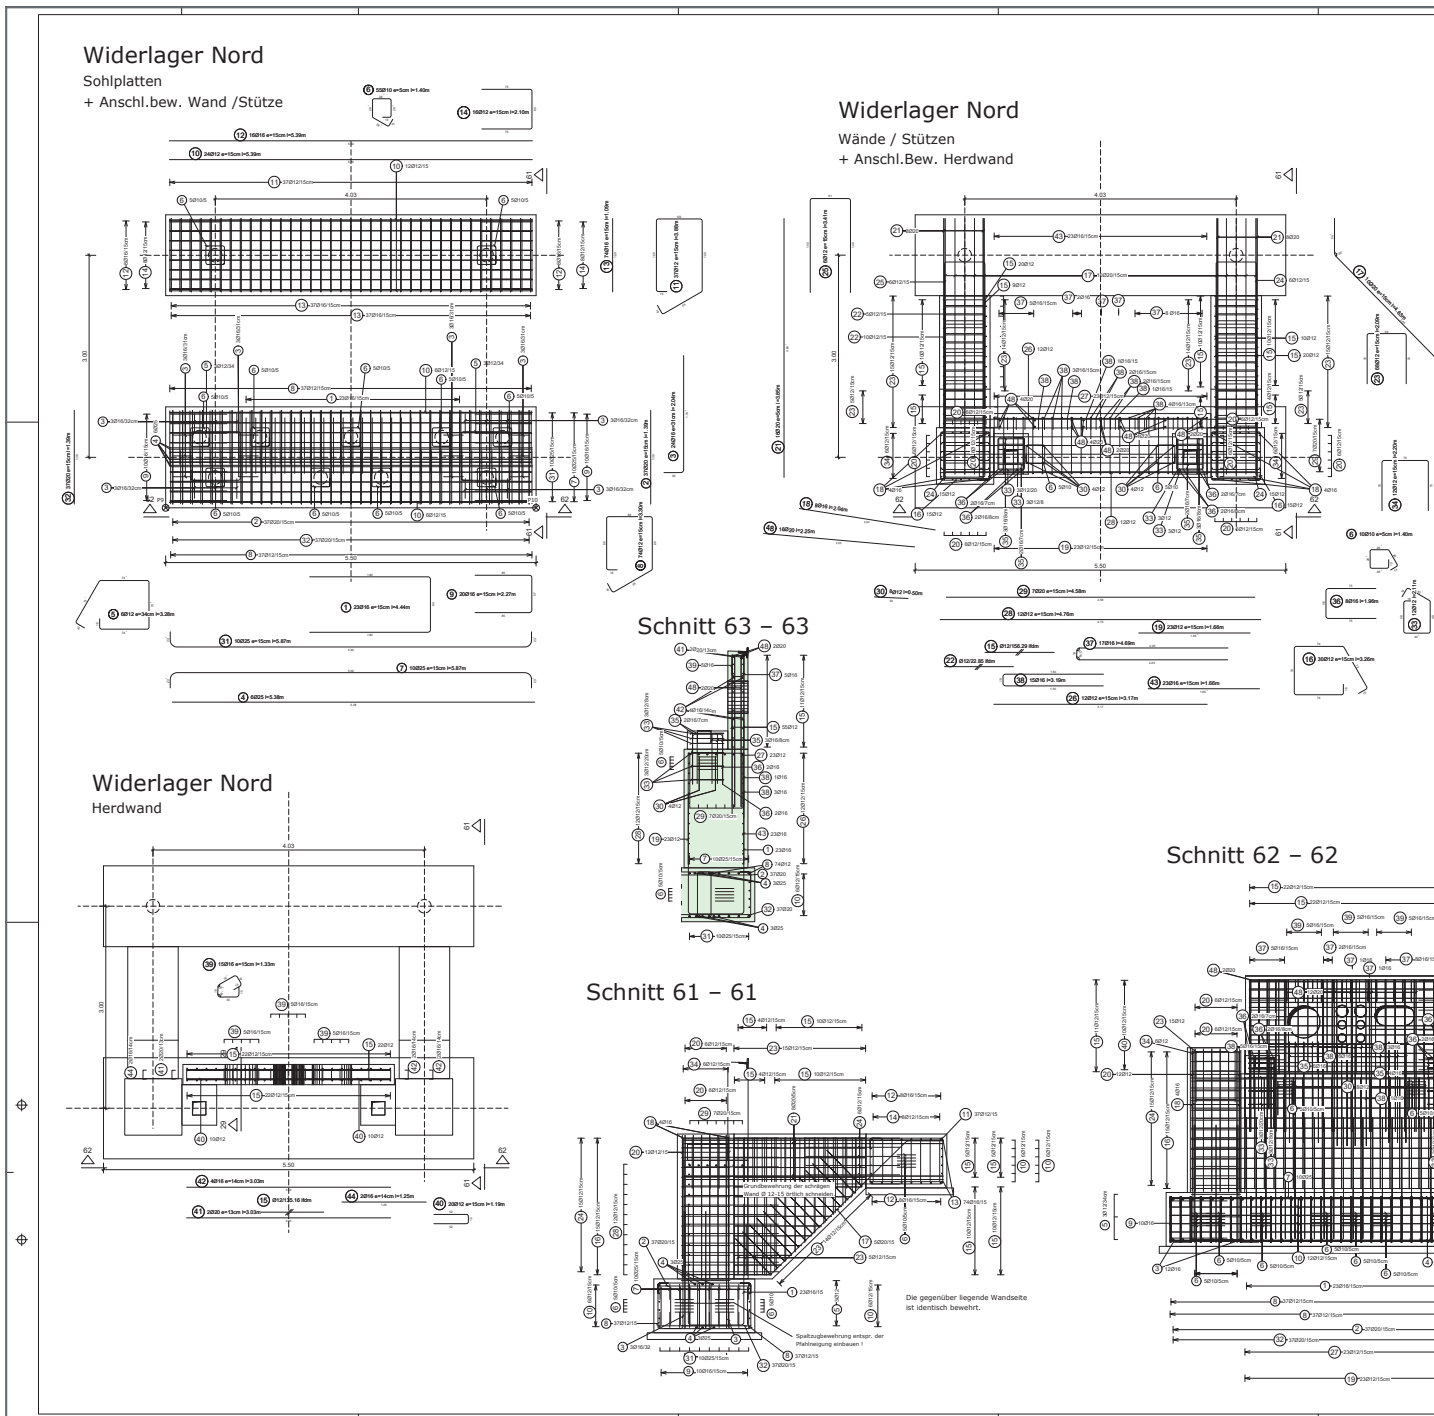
Plan Bewehrung, Zeichnungen abgeleitet aus dem 3D-Modell in ViCADO
